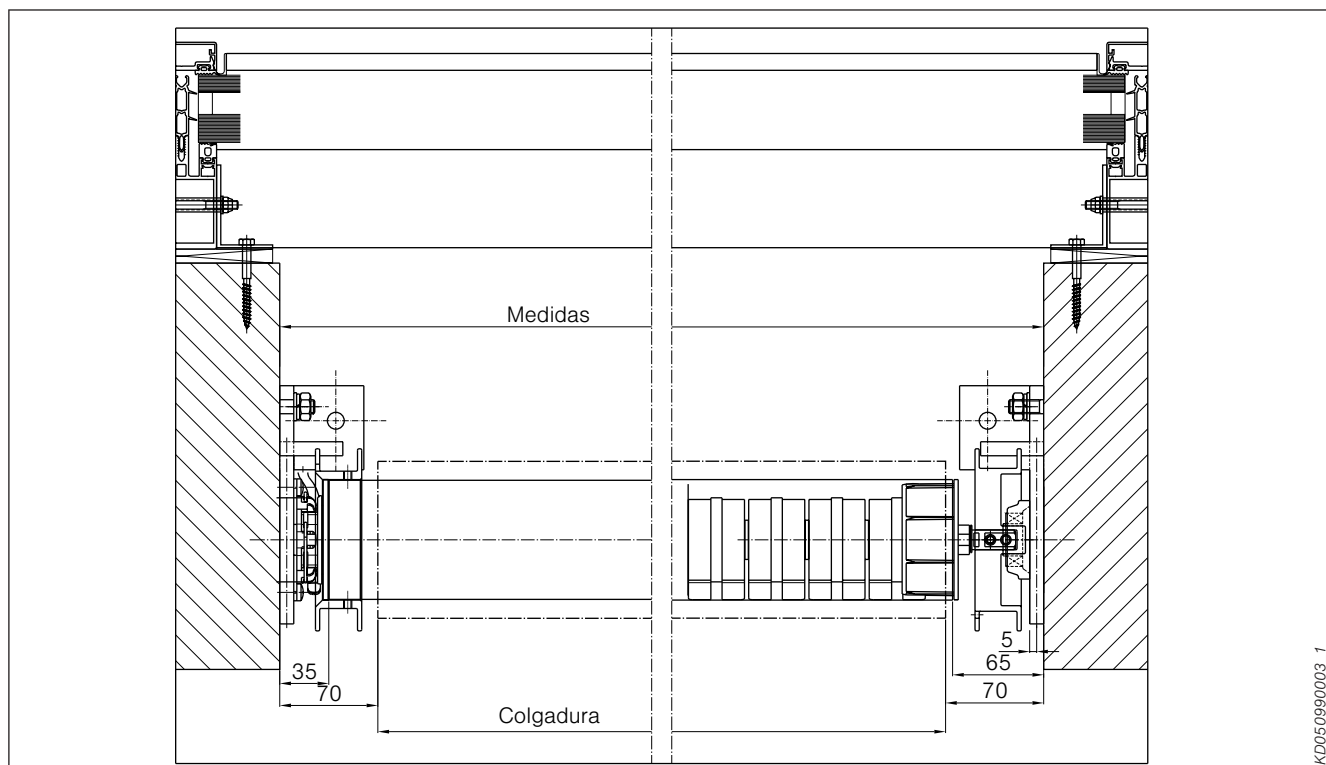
Sección del sistema – Cojinete del eje del tejido en la viga laminada
